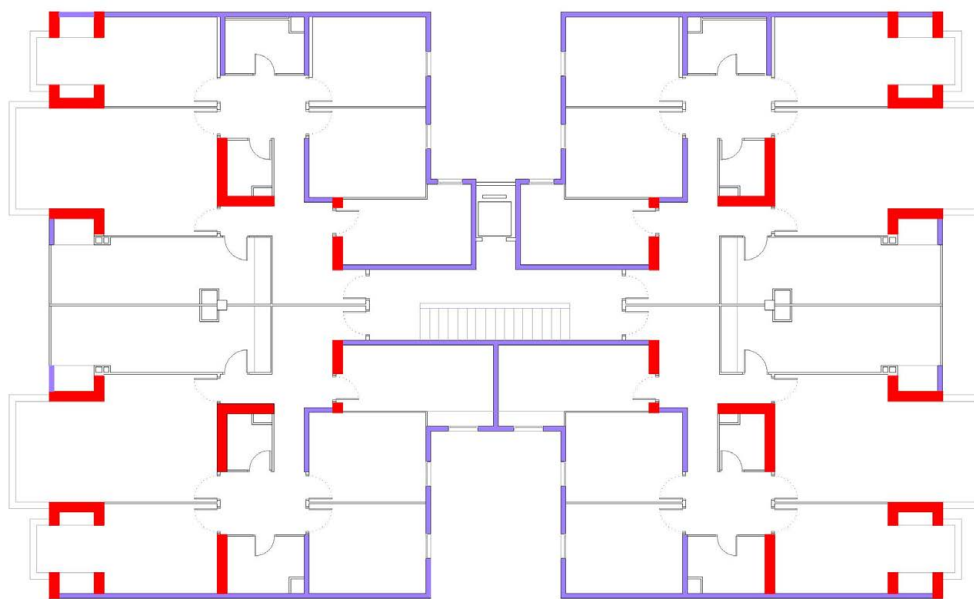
Esquema planta edificio calle Lepanto. Arquitecto Lluís Nadal
